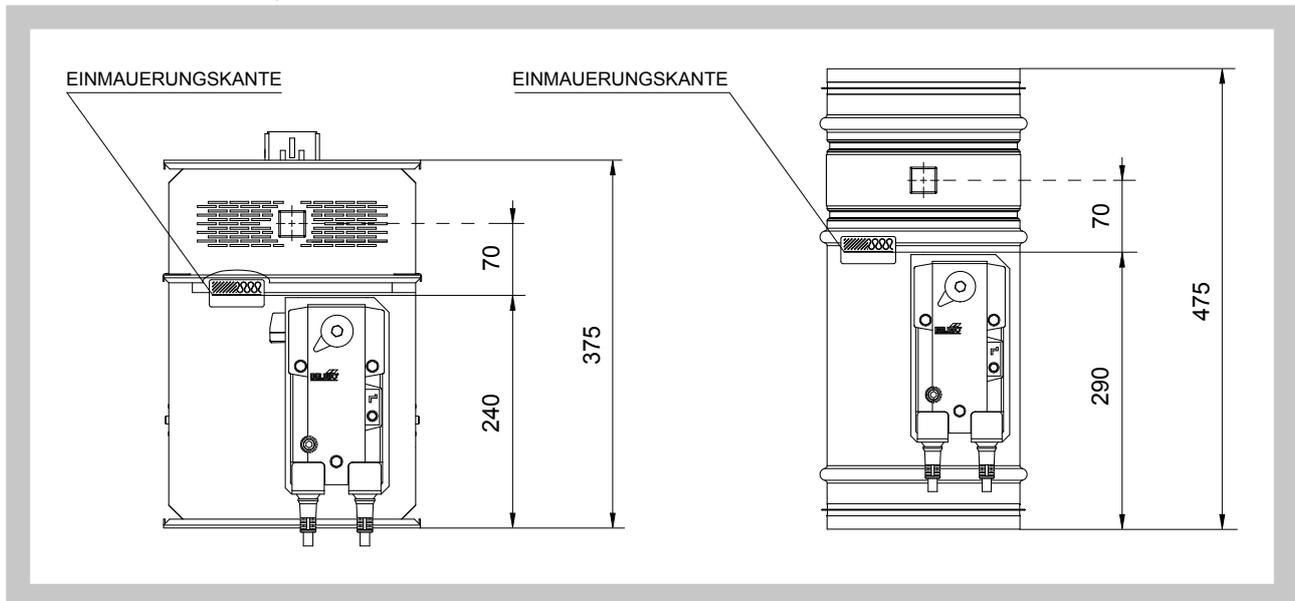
Bauöffnung - eckige Entrauchungsklappe
